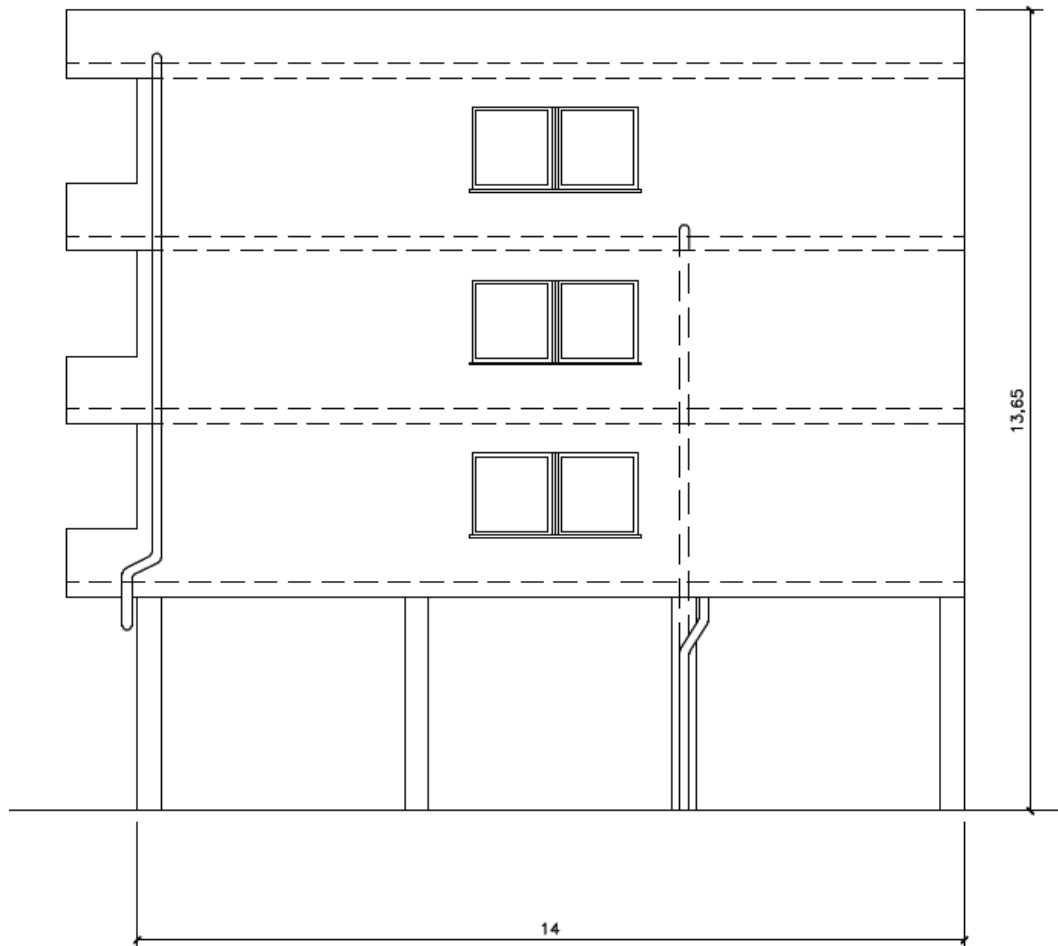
Façana lateral dreta, indicant la situació del baixant a substituir. *Font: projecte per la rehabilitació forjat piscina i sostre planta baixa i modificació baixant (any 2013)
